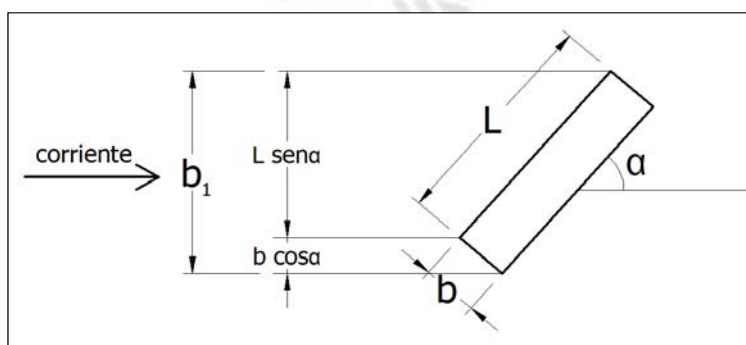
6, Ancho proyectada de la pila b_1 ⁶
